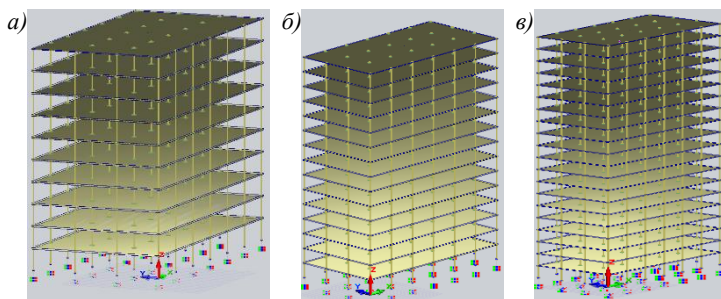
Расчетные схемы монолитных каркасов: а – 10 этажей; б – 15 этажей; в – 20 этажей
